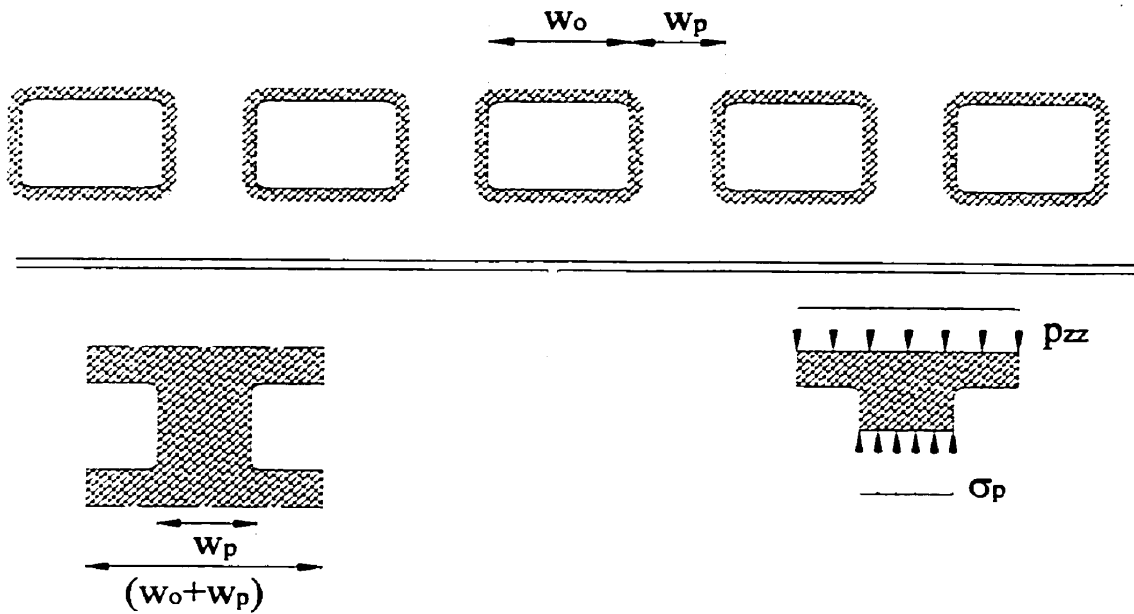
Théorie du bloc tributaire cas de piliers mur montrés en section longitudinale, [B.H.G. Brady et E.T. Brown, Rock Mechanics For Underground Mining, 1985].
